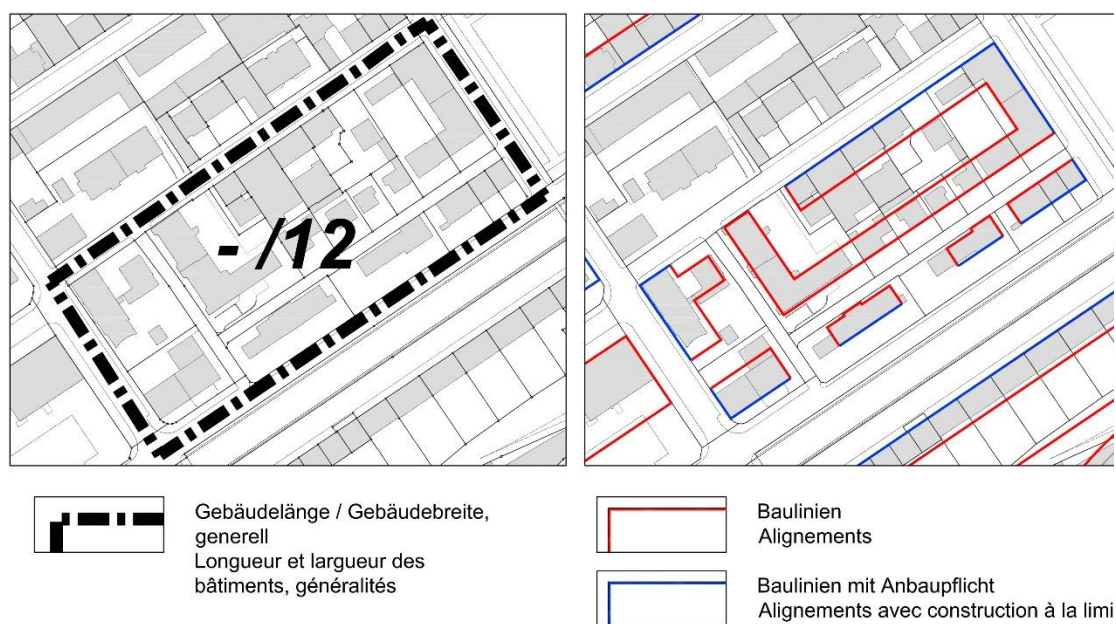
(schémas du plan de zones à bâtir et du plan des alignements) : le plan de zones à bâtir fixait jusqu'ici une profondeur maximale de 12 m pour ce secteur. Vu que le plan des alignements définit déjà les secteurs constructibles de tous côtés, on peut donc renoncer à fixer la largeur des bâtiments.
